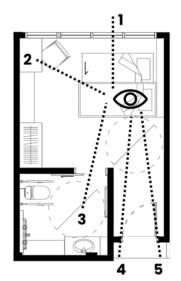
Layout Sirkulasi Pada Suatu Bangunan Sumber: Penulis, 2023
